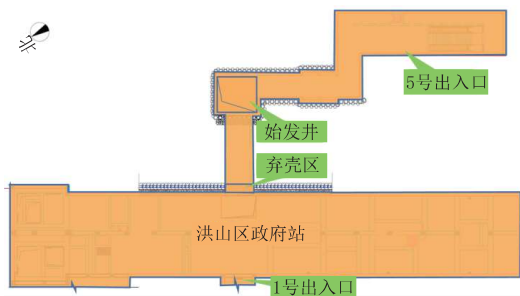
洪山区政府站V号出入口顶管工程平面布置示意图
